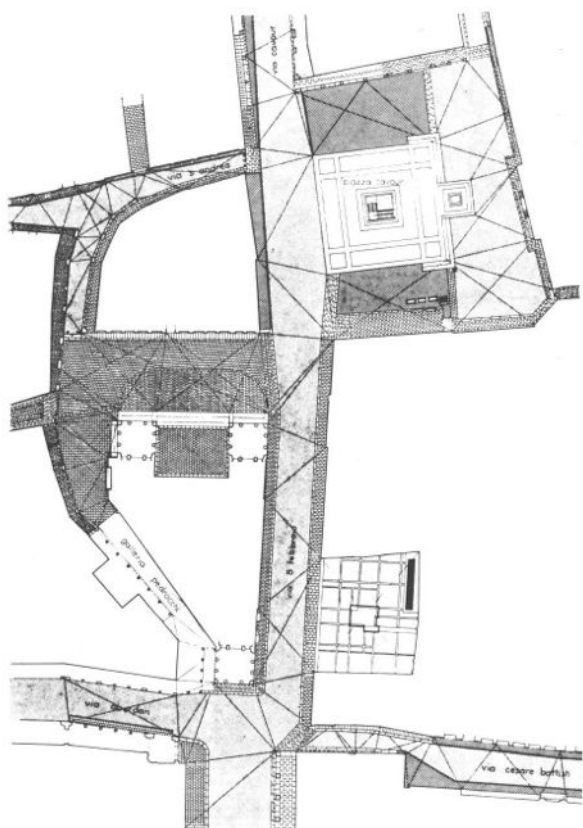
e 28. Rilievo planimetrico delle pavimentazioni preesistenti nell'area di intervento più a nord e progetto della stessa zona.
